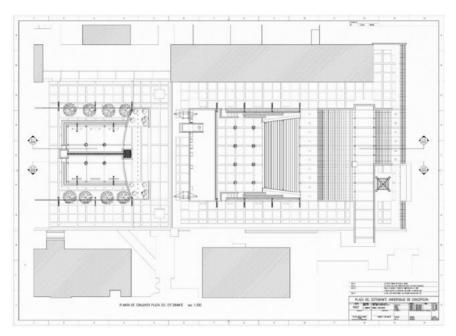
Lámina A 001, Plano de Conjunto. Muestra el proyecto general propuesto para el proyecto desarrollado en el año 2000. Fuente: Archivo Rodrigo Pino Moreno
